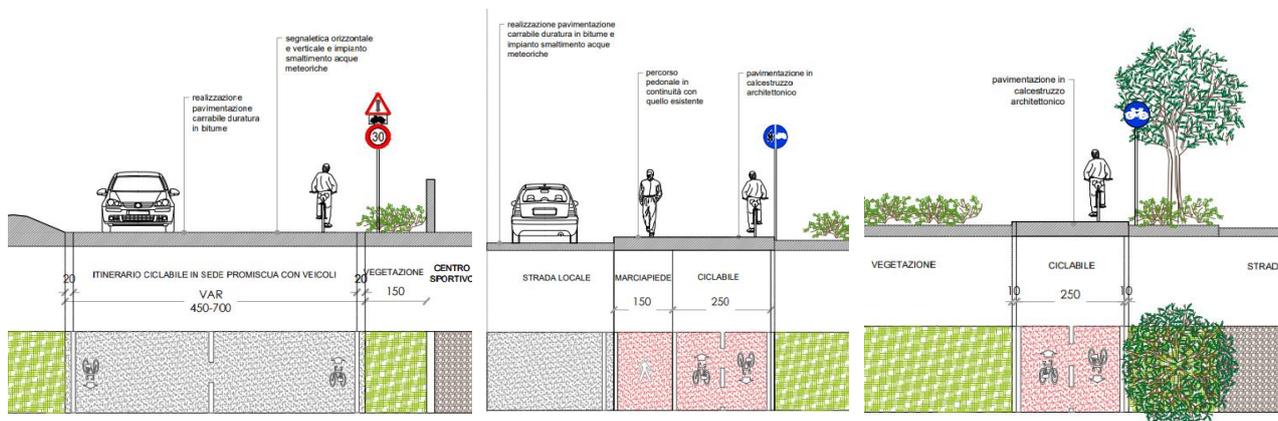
sezioni di progetto B06.I, B06.II e B06.III
